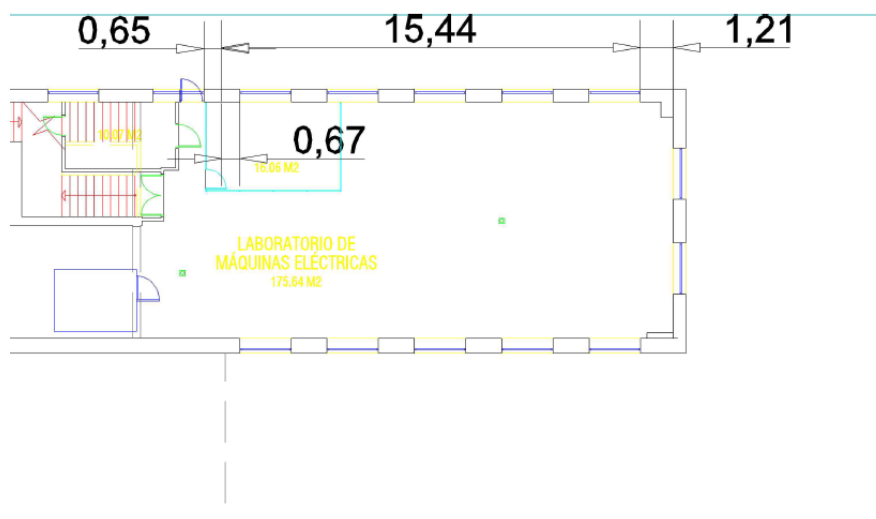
Ubicación en planta de la pendiente y la escalera del alzado sur.
